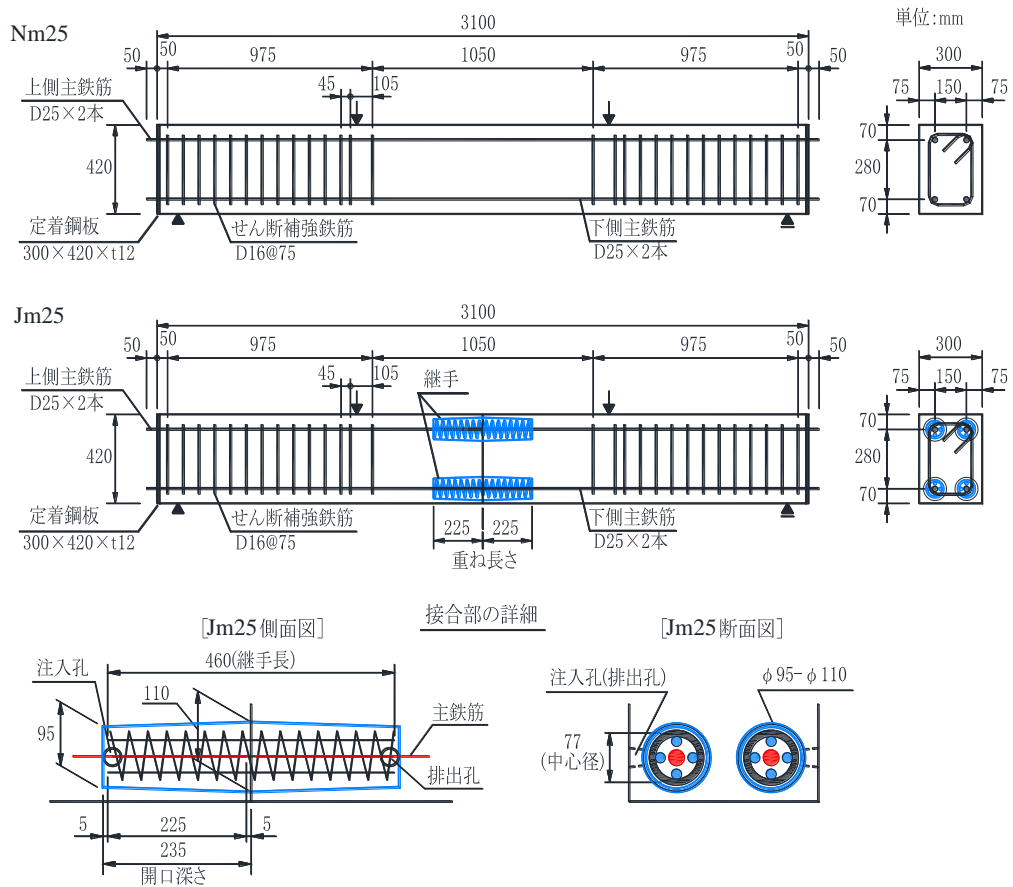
試験体の形状寸法と配筋 (D25 シリーズ)
